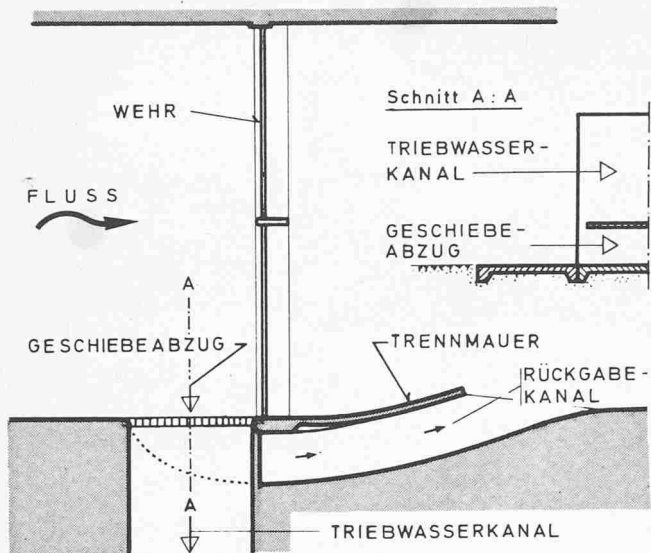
Prinzipielle Darstellung einer Fassungsanlage mit Geschiebeabzug
